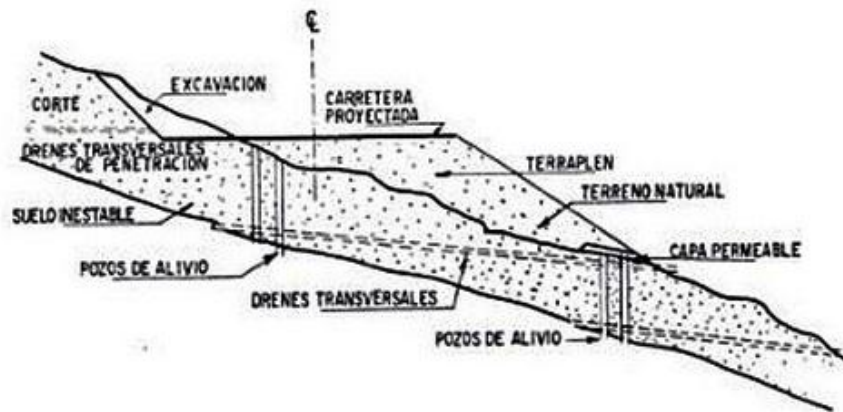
Pozos de alivio combinados con drenes de penetración transversal.
